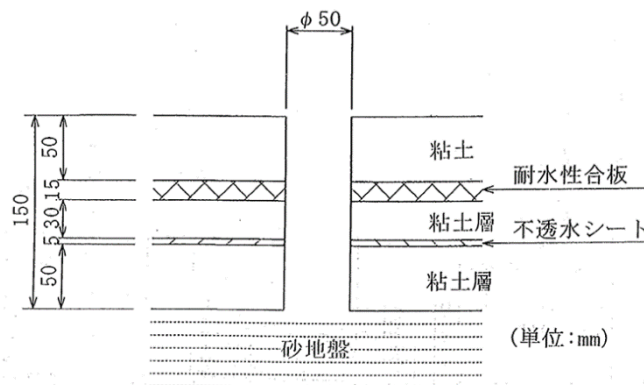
三木ら (1996) ²⁾ 大型パイピング実験 弱部 (漏水口) 構造
